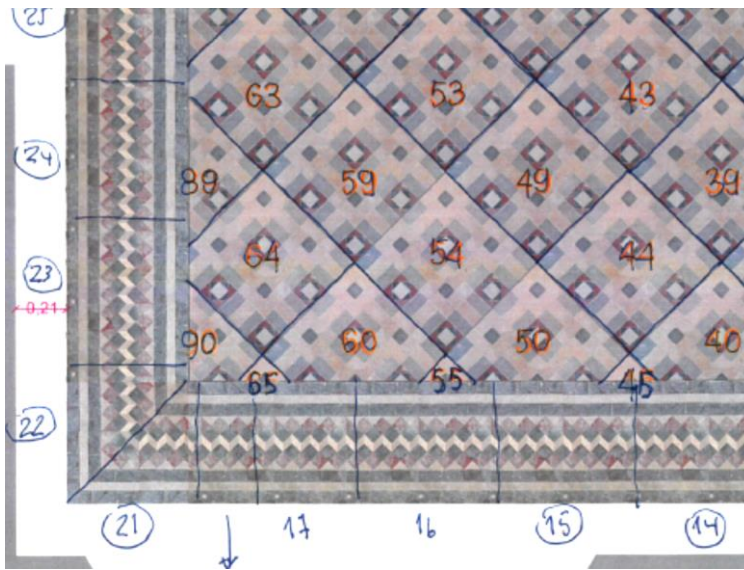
Pavimento Nolla existente: (a) Cenefa perimetral. (b) Paño. Fuente: Propia
